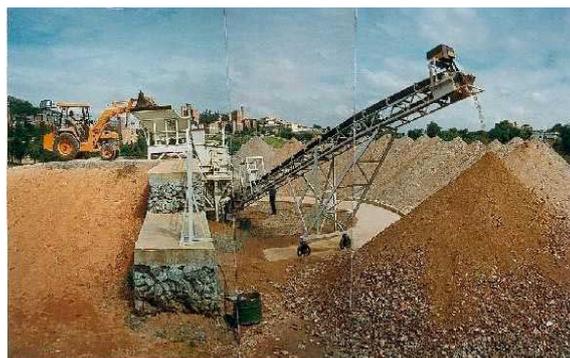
Estação de Reciclagem “Estoril” em Belo Horizonte (PINTO, 1999).
